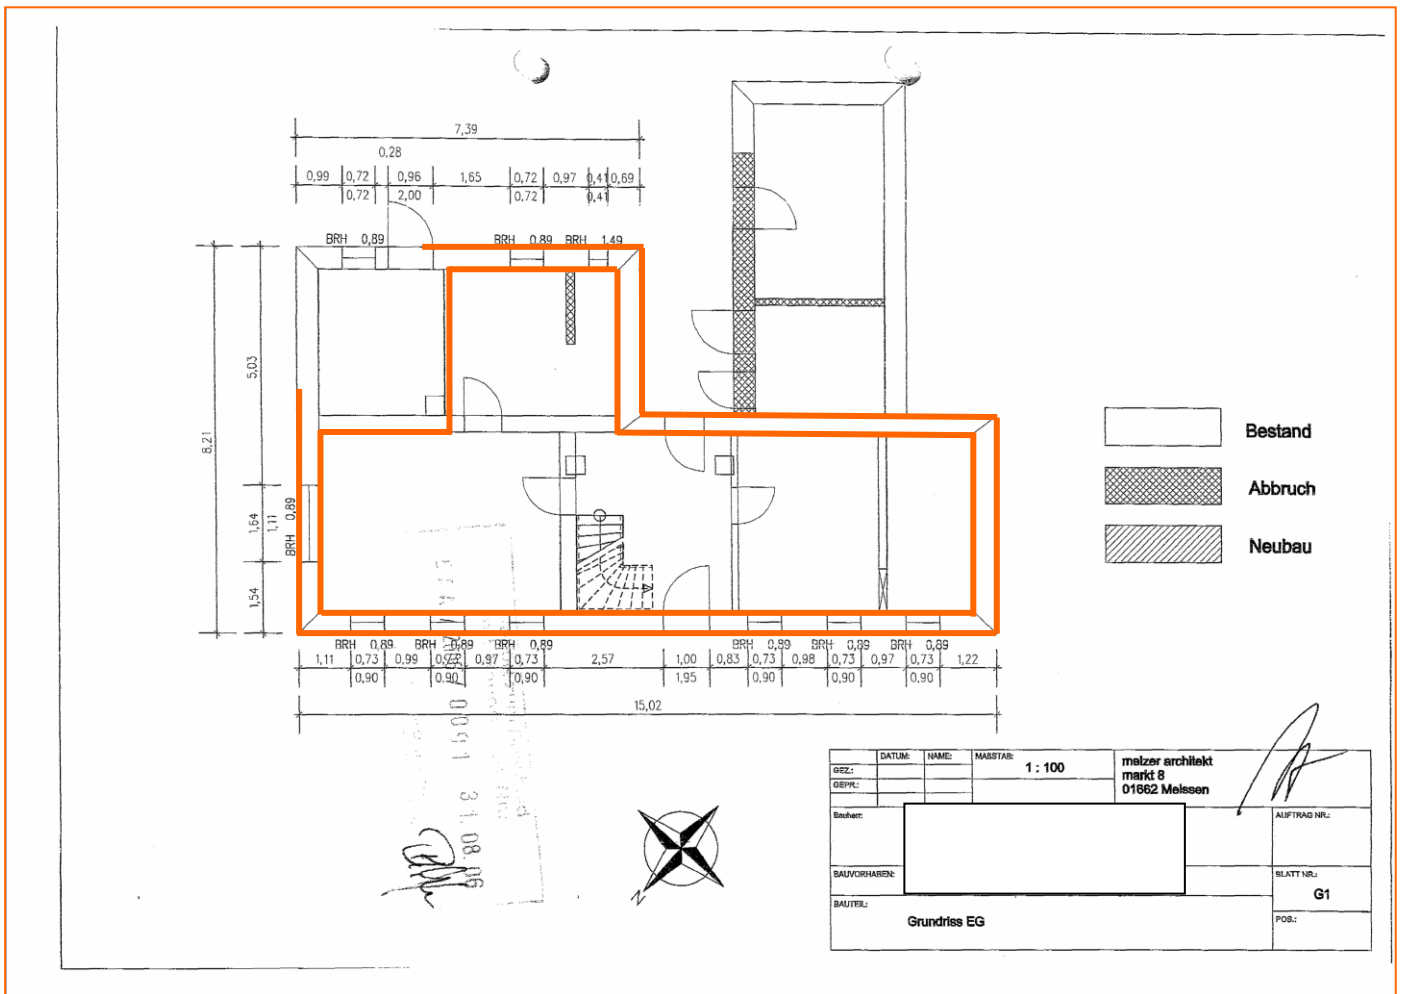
Grundriss EG mit Darstellung der thermischen Hülle / Systemgrenze
